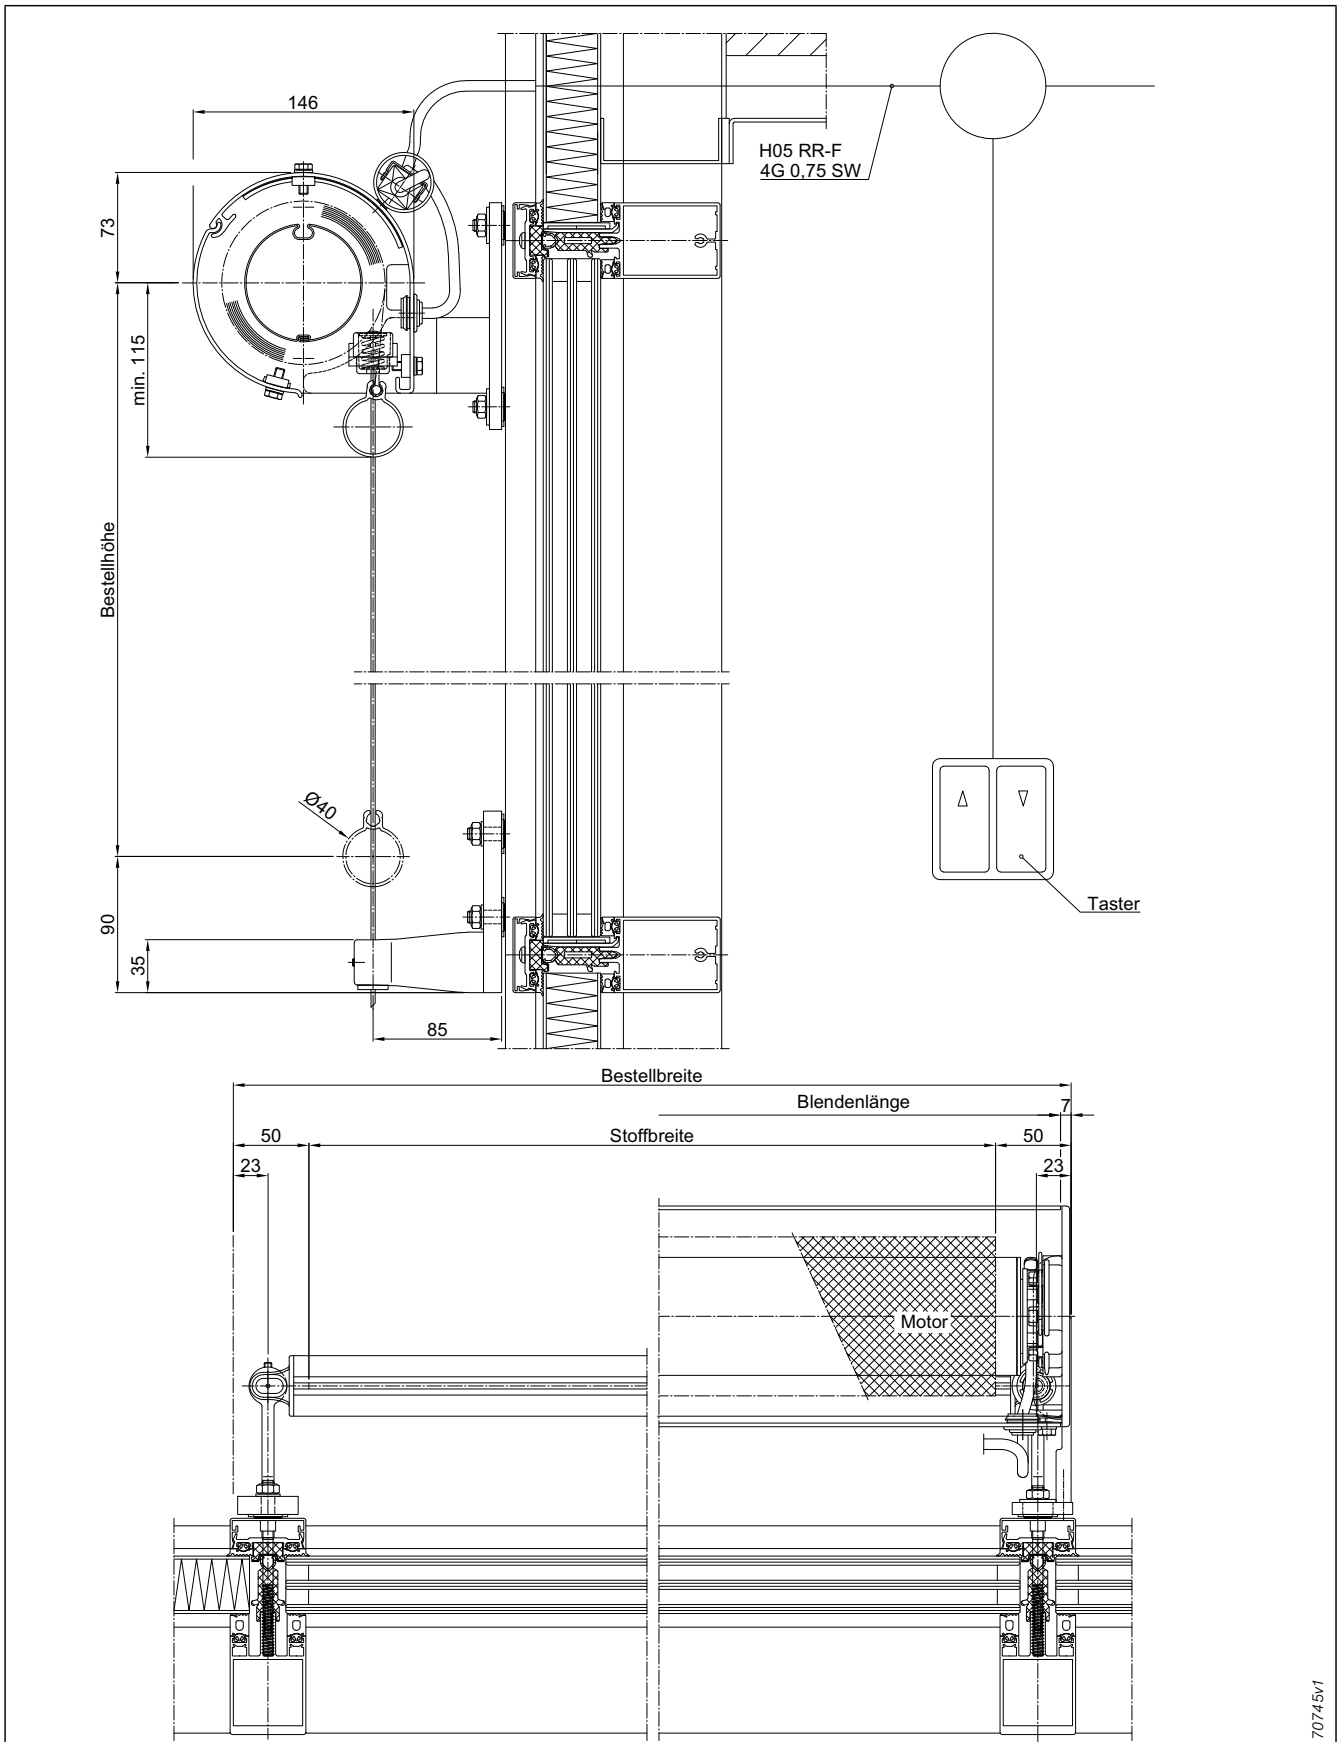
Fassaden-Markise 207 mit Rundblende Typ 8.3
